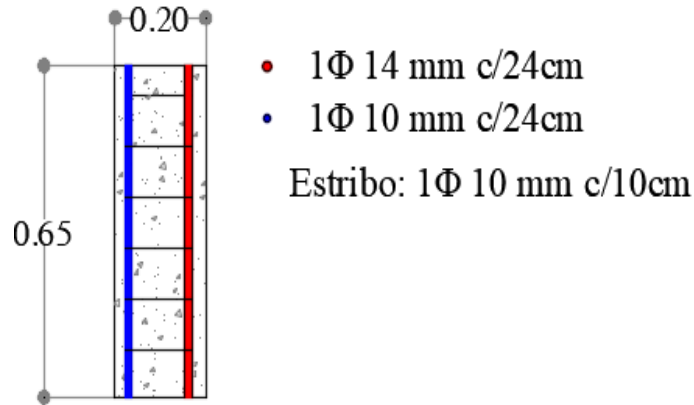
Armado del parapeto, análisis en sentido transversal (vista frontal)
